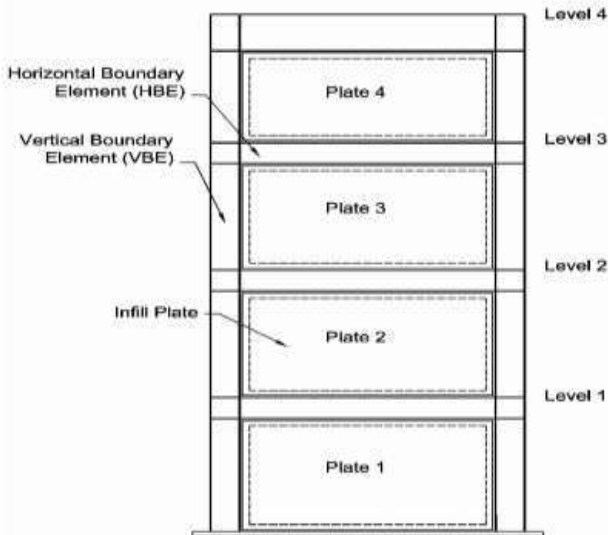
Typical Steel Plate Shear Wall (Astaneh-Asl, 2000)
